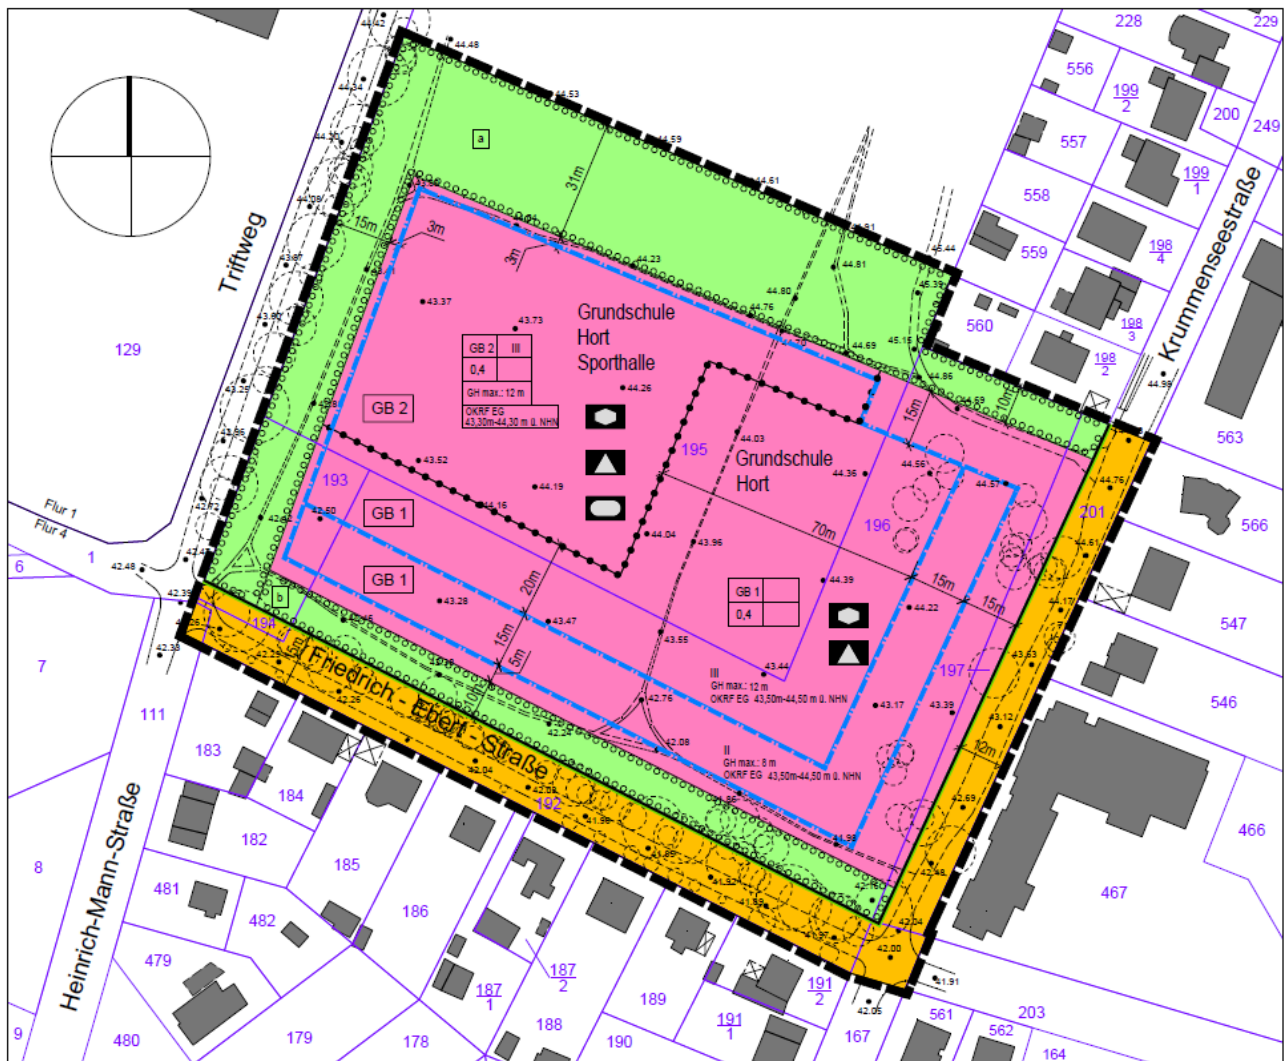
Bebauungsplan Nr. 31/22 „Grundschule Krummenseestraße/Friedrich-Ebert-Straße/Triftweg“ Gemeinde Schöneiche, Stand 25.04.2024
